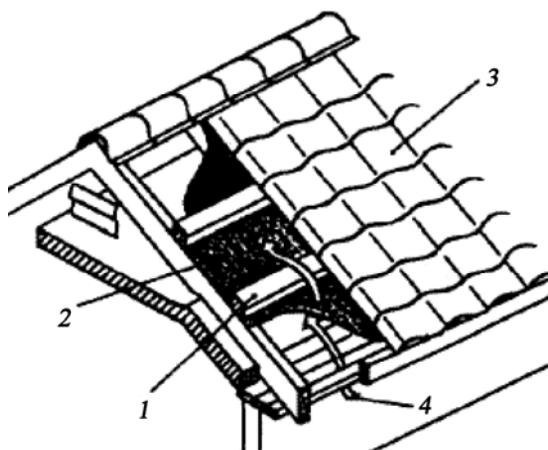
Конструкция крыши с кровлей из металлочерепицы:
